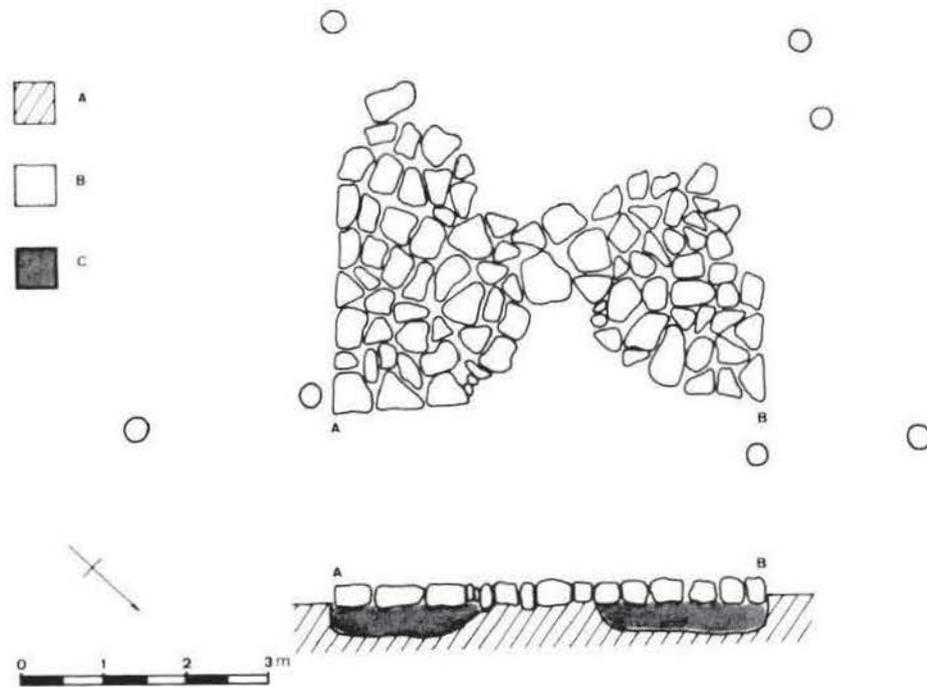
Planta y perfil de la cimentación del monumento. A: nivel del suelo vegetal; B: parte de la planta reconstruida; C: cimentaciones.
